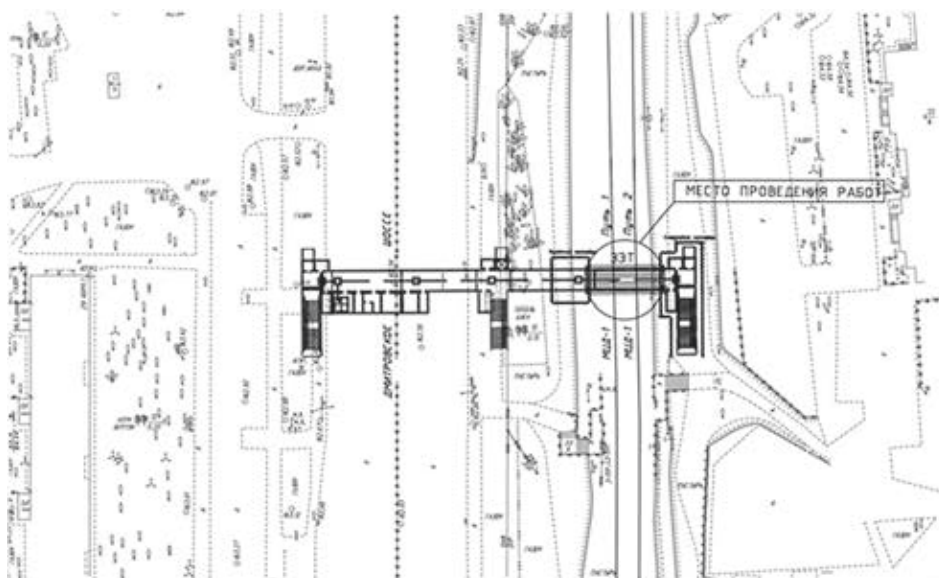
Ситуационный план строительной площадки / Fig. 1. Site plan of the construction area
